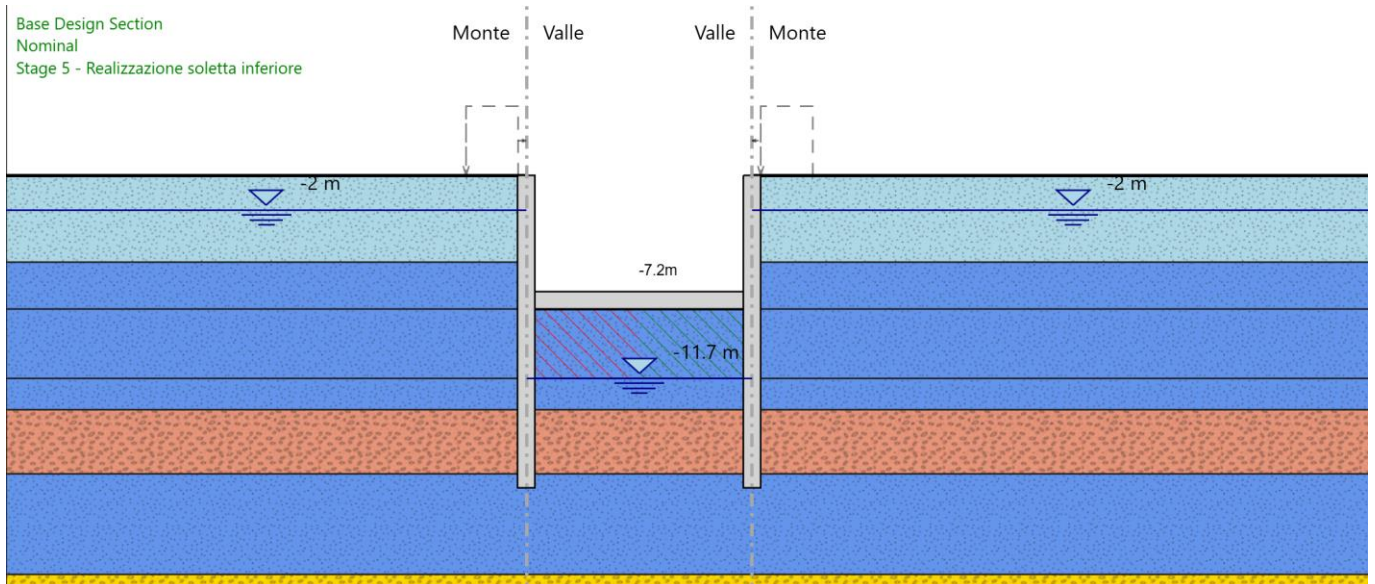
Fase 5: Realizzazione soletta di fondazione
